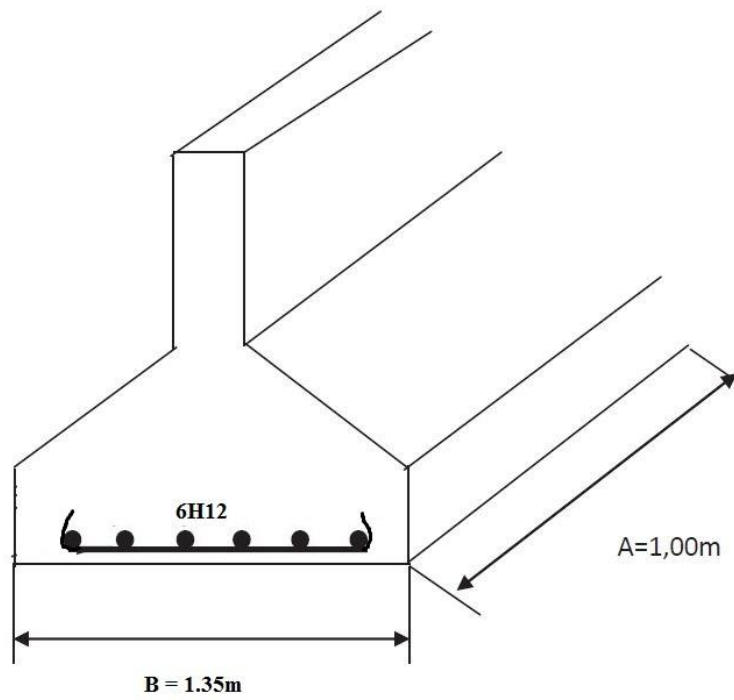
exemple de coupe de ferrailage de semelle filante
